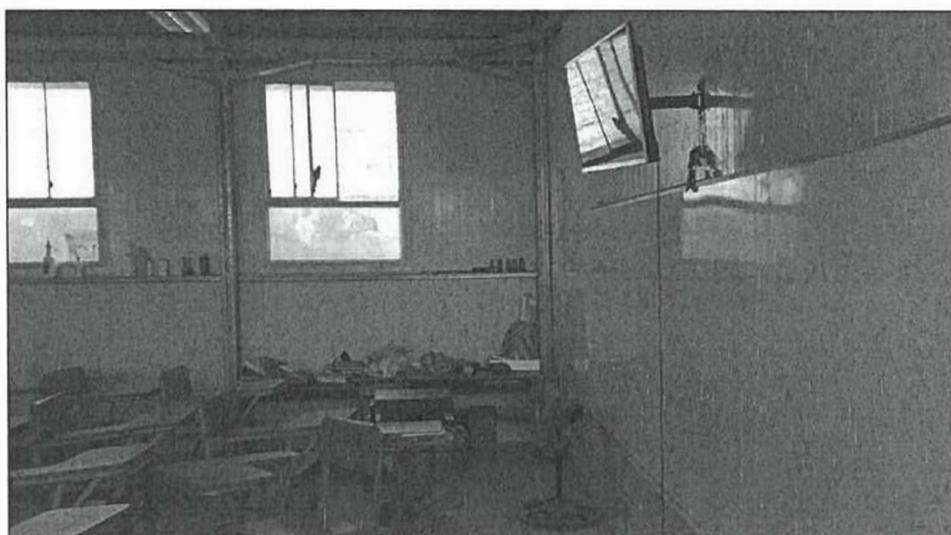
Vista fotográfica del interior de módulo prefabricado 2, utilizado como aula.
